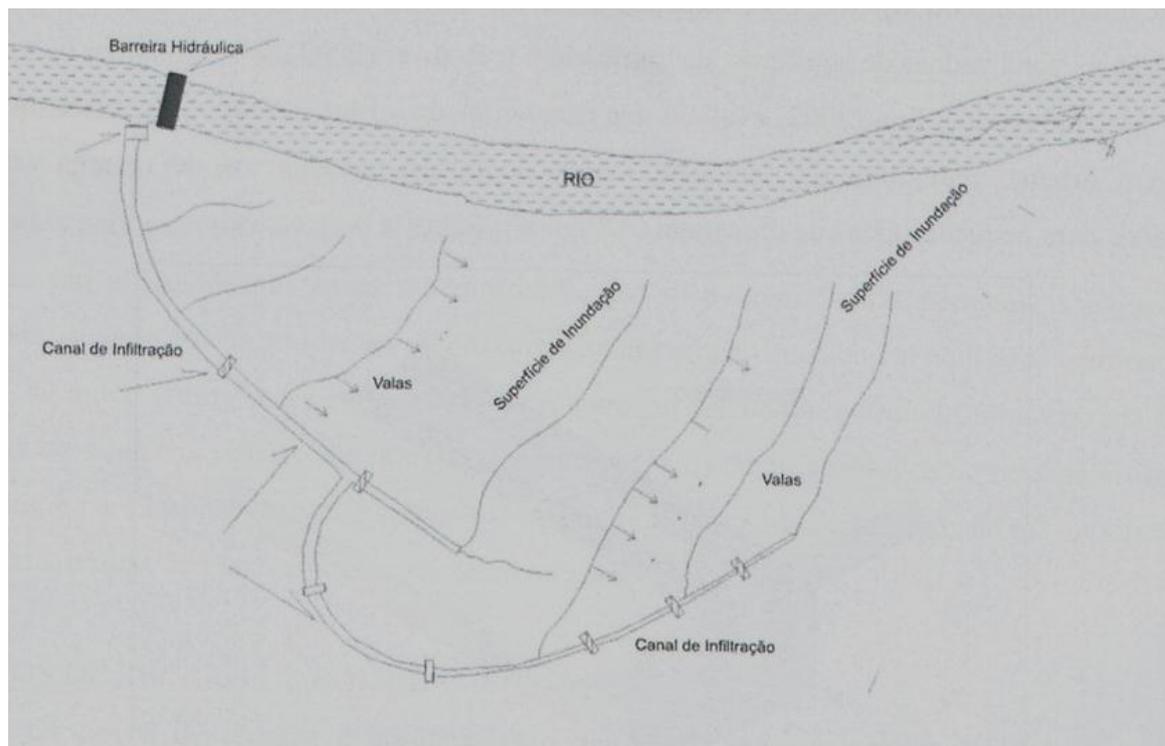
Recarga em planície de inundação com valas e canais de desvio (Almeida 2011).
